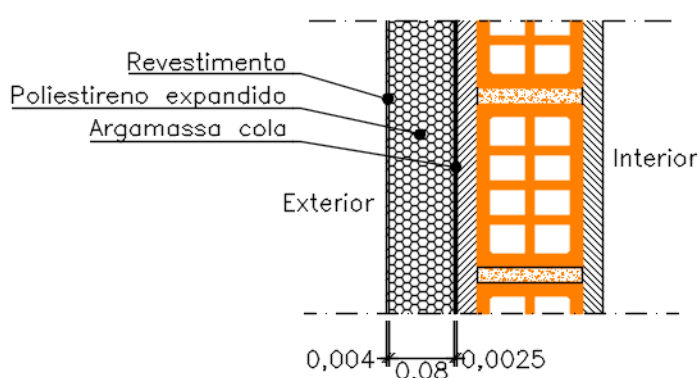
Pormenor construtivo como proposta de intervenção de parede exterior - PRE2
